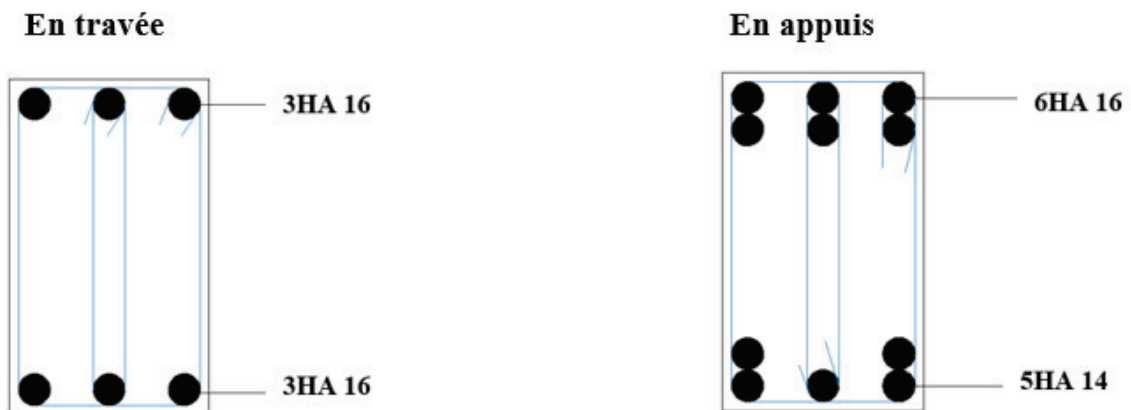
Schéma ferrailage des poutres transversales 55 x 30.
